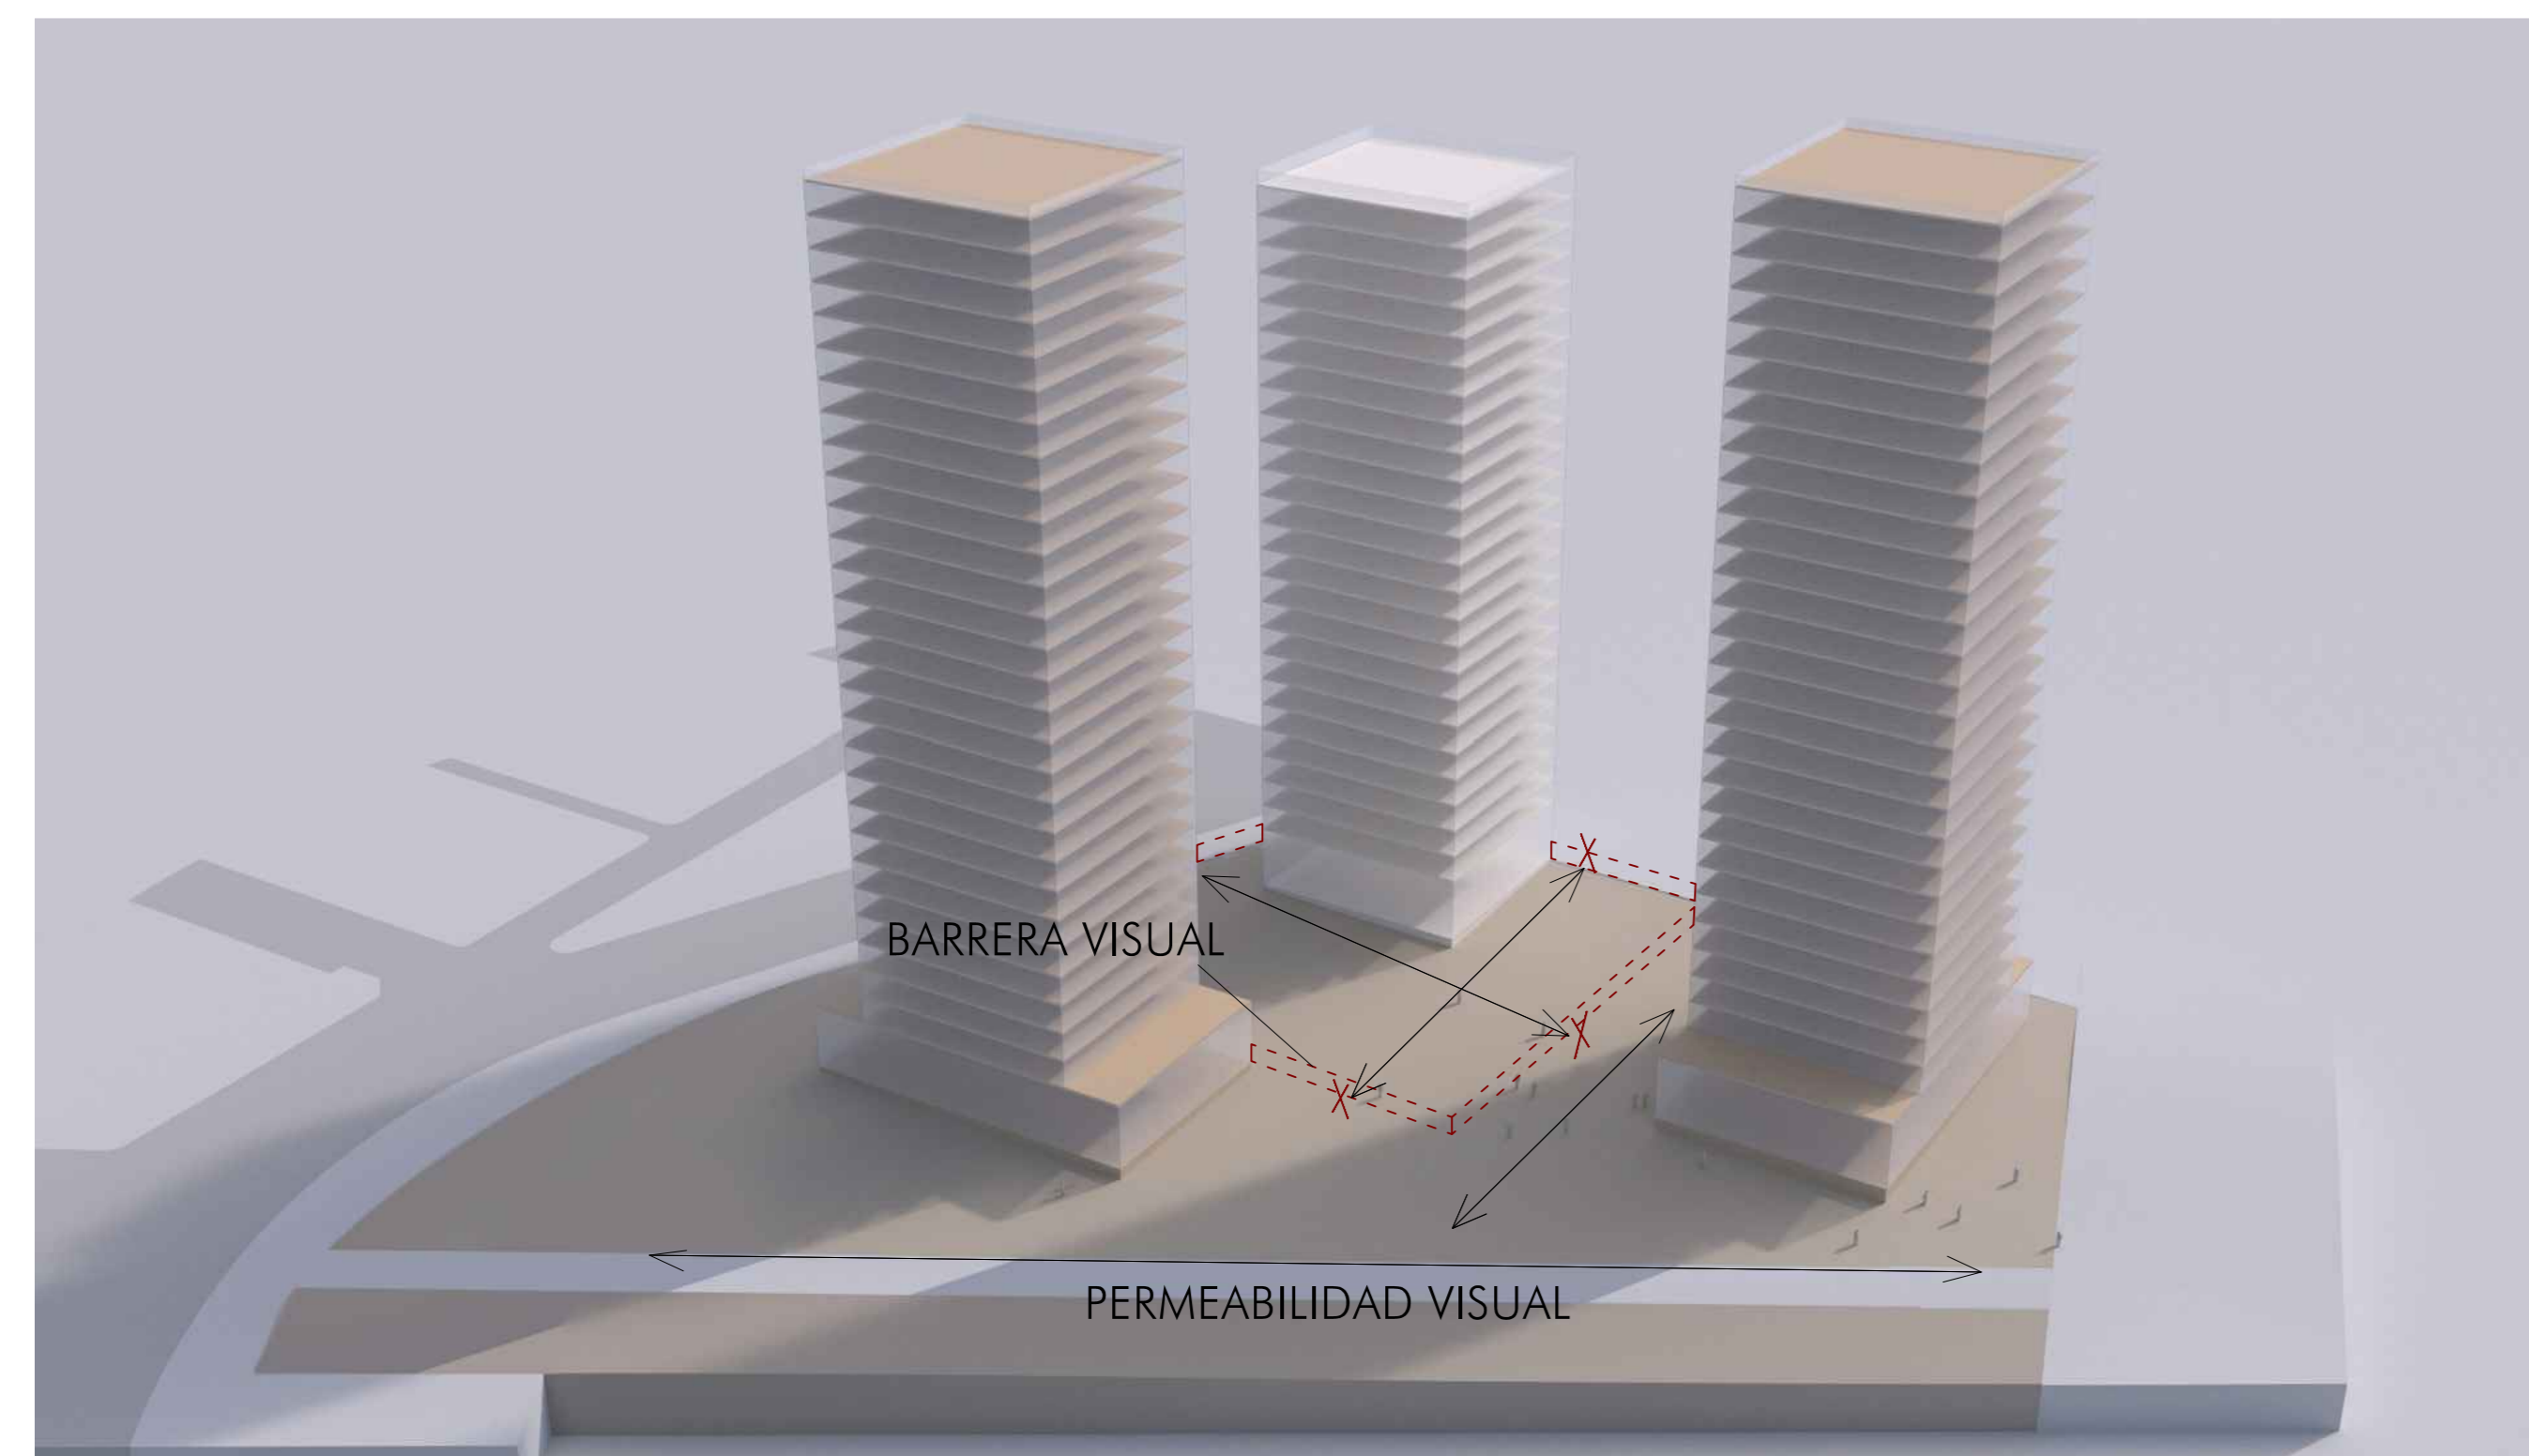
IMAGEN DE LA PROPUESTA. VOLUMETRÍA
